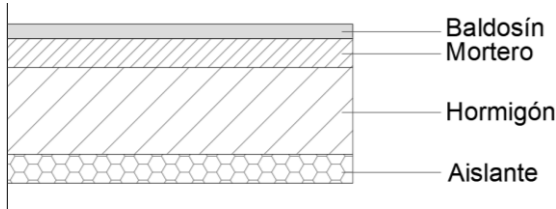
Detalle sección constructiva de la cubierta del prototipo
